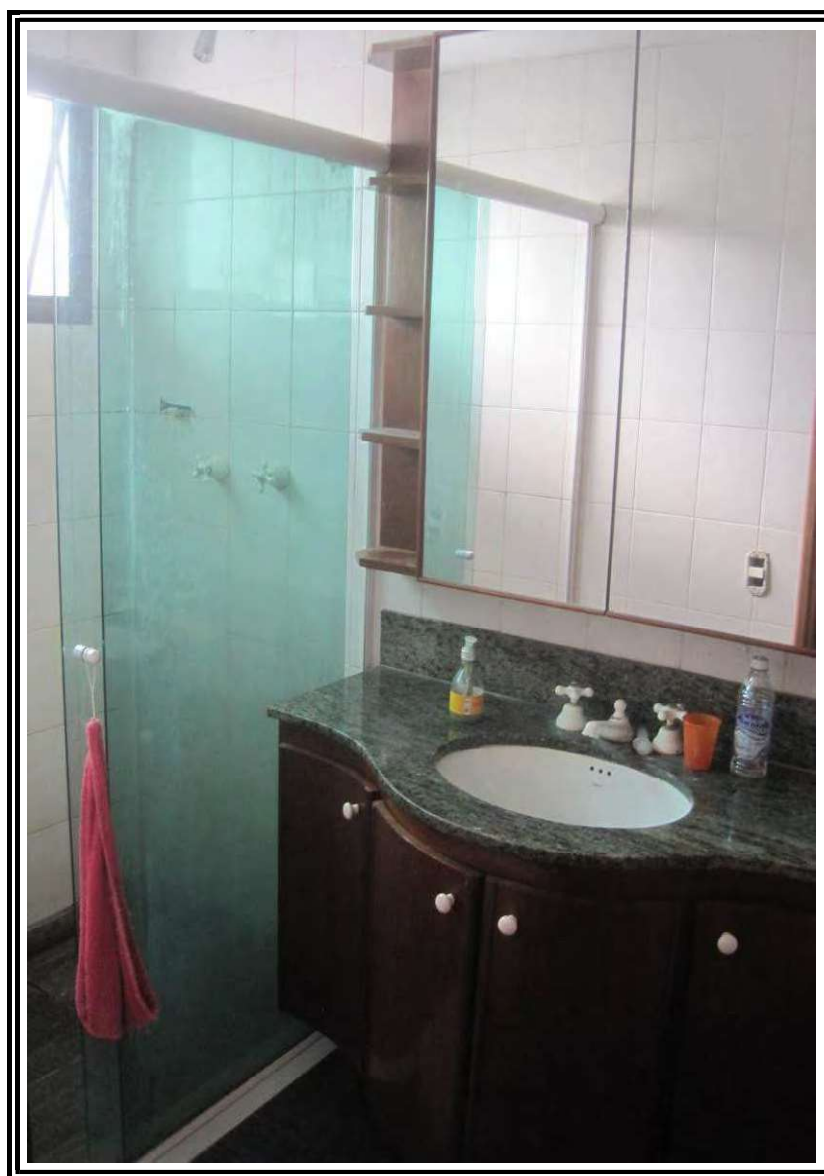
Vista do banheiro do dormitório 04 (suíte)
